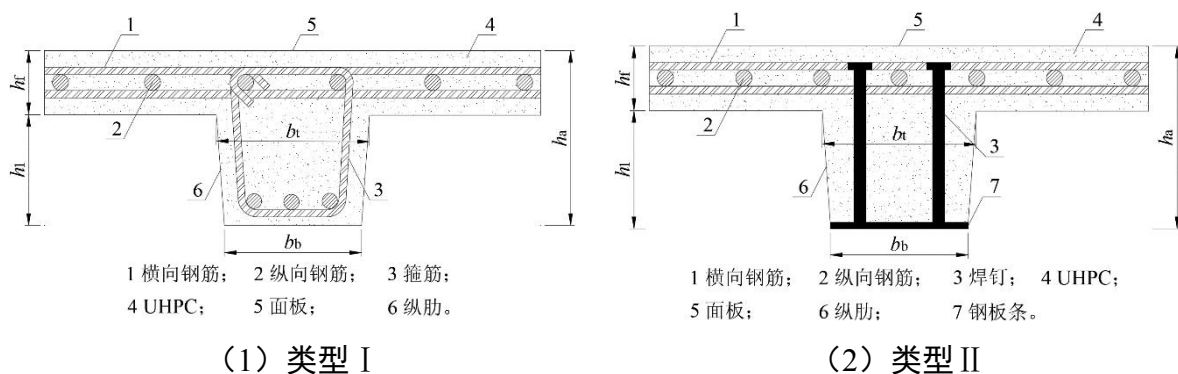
超高性能混凝土矮肋板尺寸示意图
